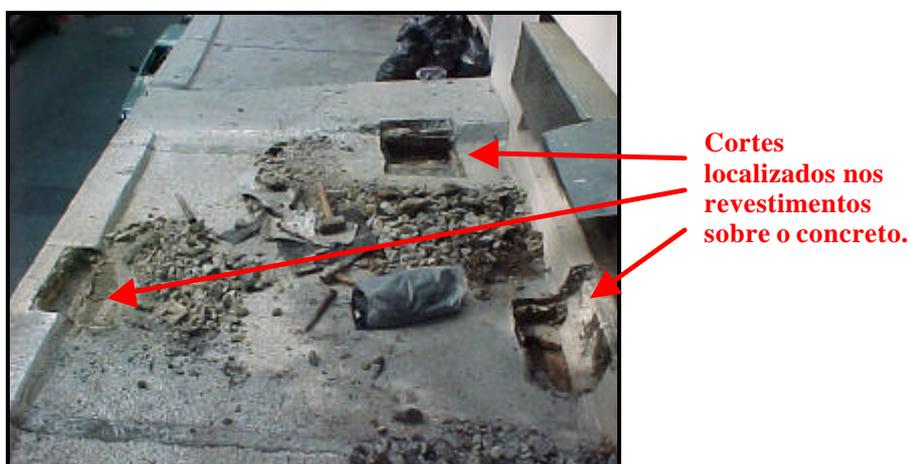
Cortes no revestimento para verificação da estratificação de camadas.
